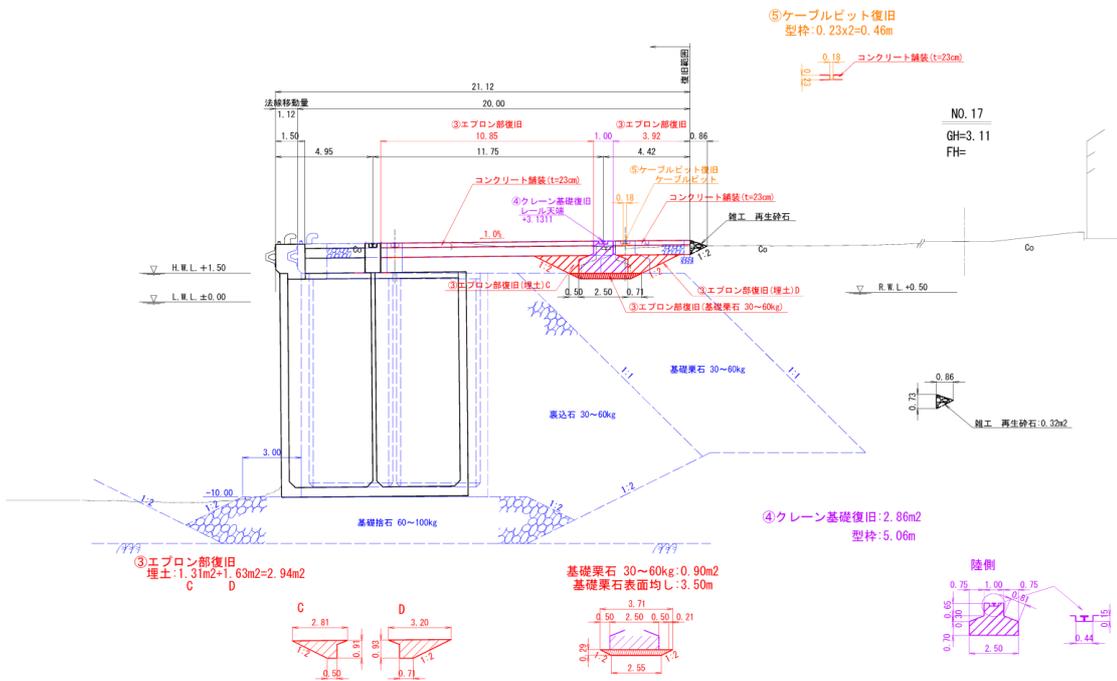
No.4 日立港区_第1ふ頭地区 1-D 岸壁 (-10.0m) の断面図 (復旧後)
